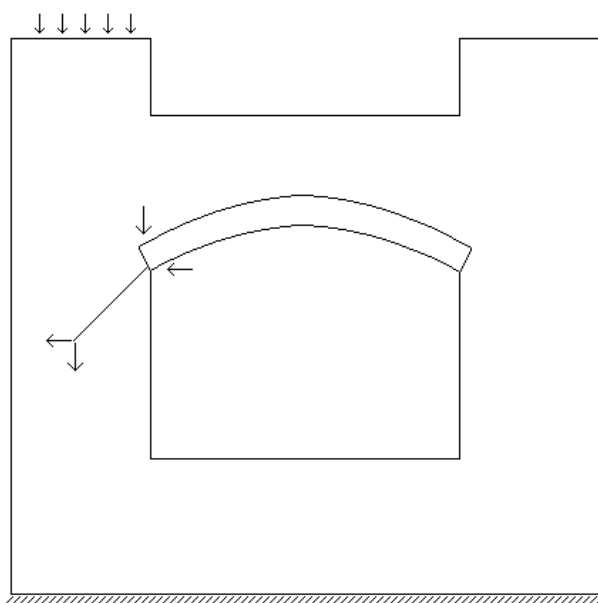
Buekonstruktion ved enden af en facade
